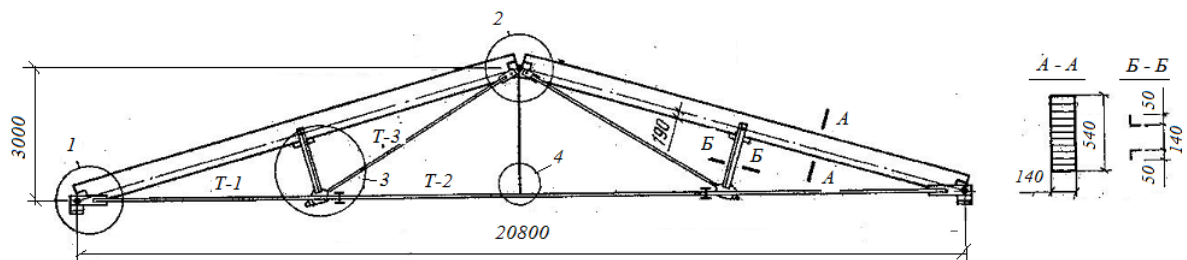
Треугольная ферма пролетом 20,8 м с клееным верхним поясом
